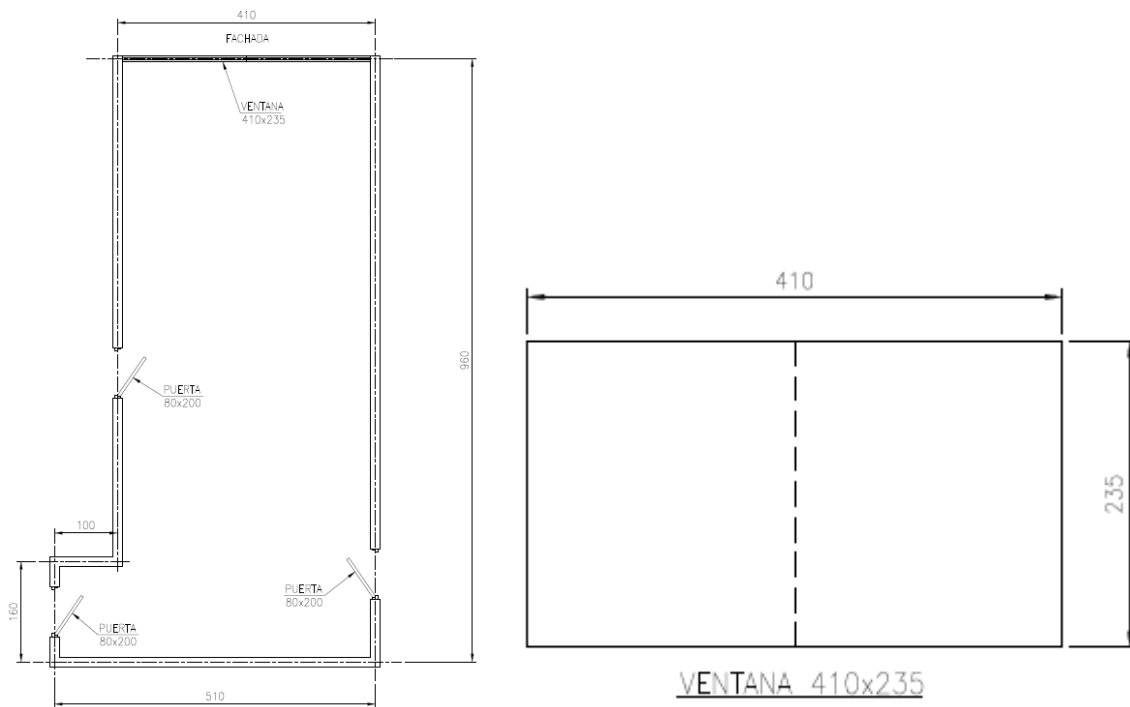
Vista en planta y elevación del recinto utilizado para el ensayo.
